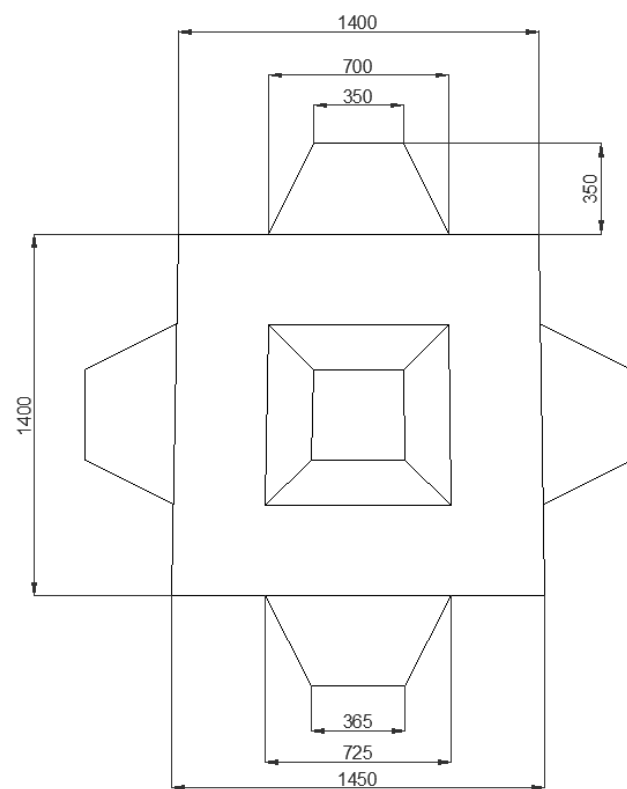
Tamaño final de los cubipodos. (Fuente: plano 5, 2023)
